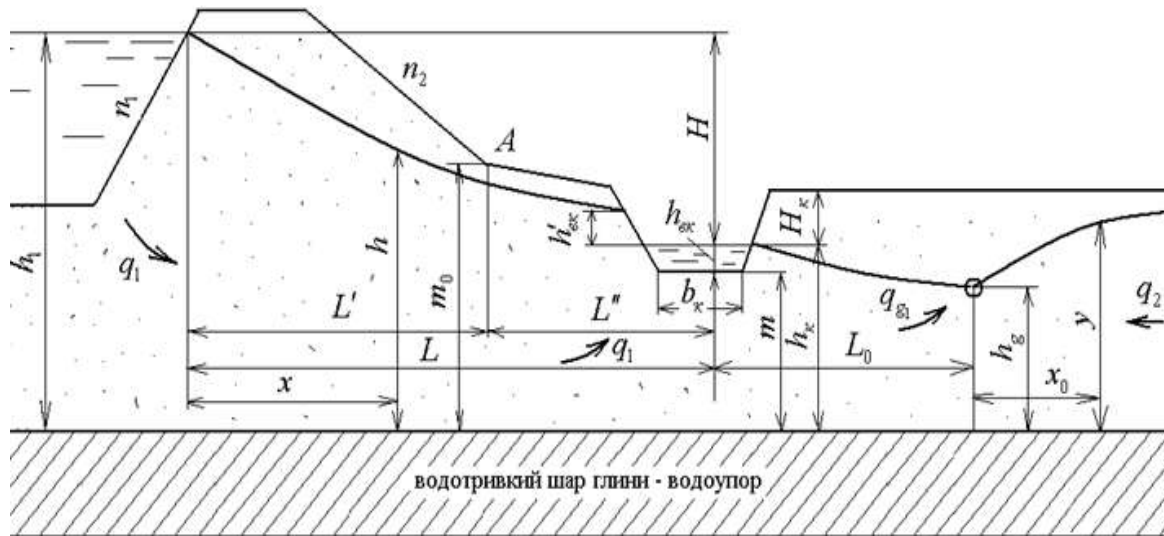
Розрахункова схема дамби (греблі) з дренажним каналом (руслom) і перехоплюючим дренажем (схема 1)
